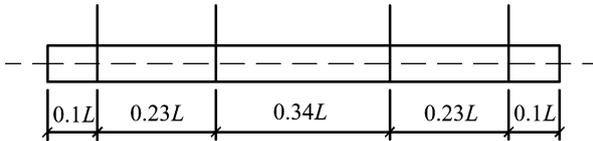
15 m ~ 30 m 长桩吊点位置
